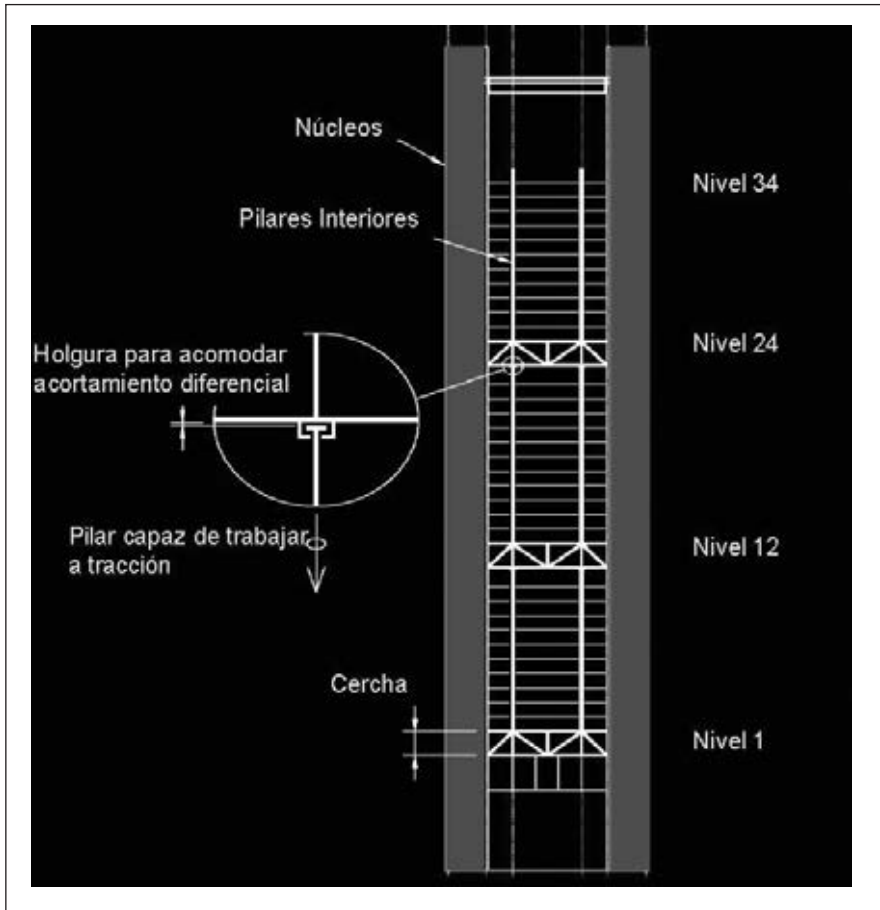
Solidez (¿rigidez?) de las cerchas principales.
